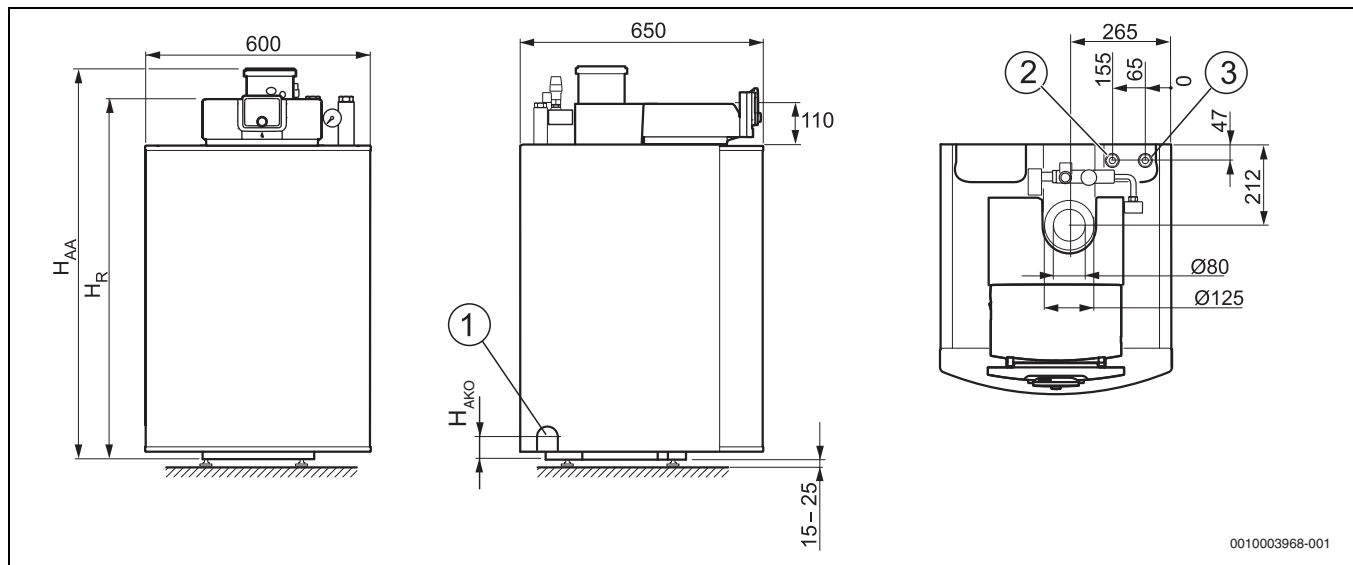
Anschlüsse und Abmessungen des Heizkessels (Maße in mm)
